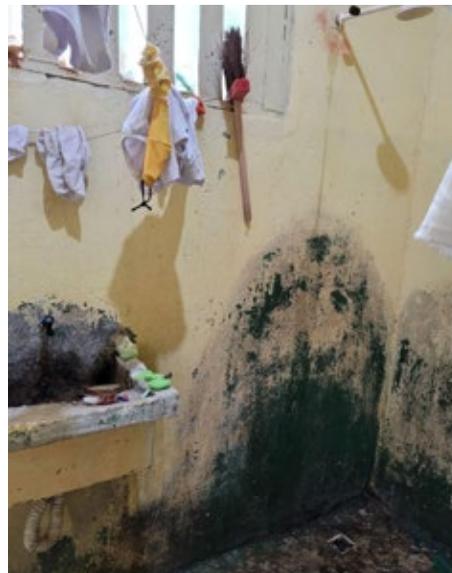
Banheiro com estrutura degradada, com infiltrações e paredes mofadas no CDF.
